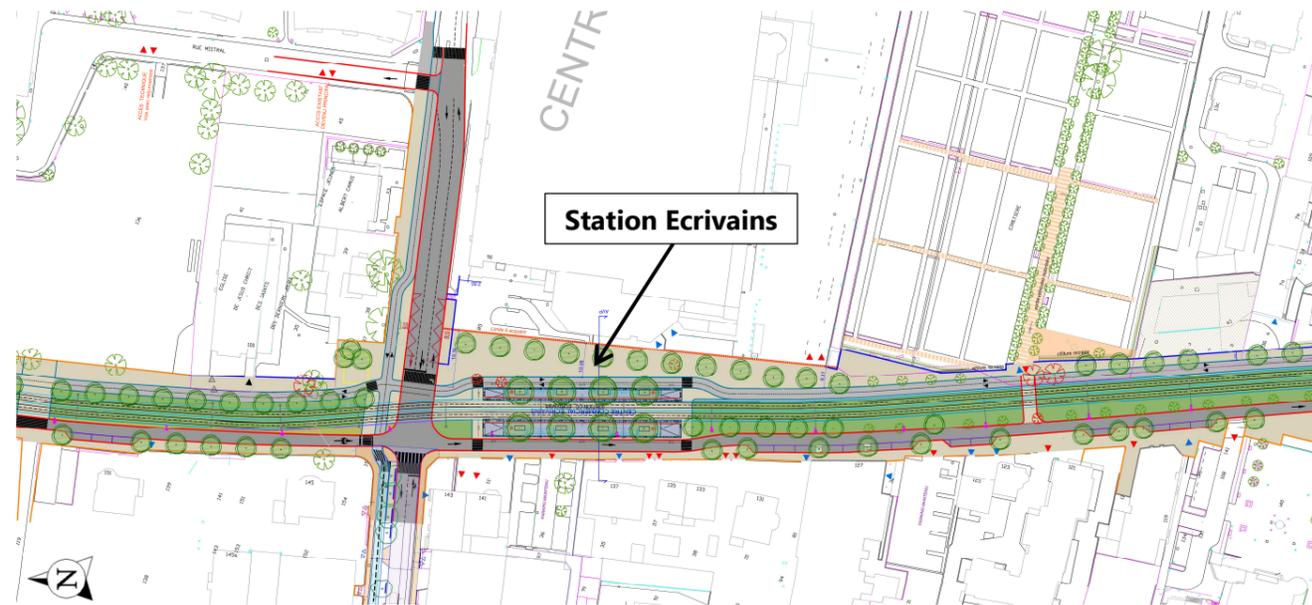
Plan route du général de Gaulle -station Écrivains (source : AVP, GETAS 2023)
